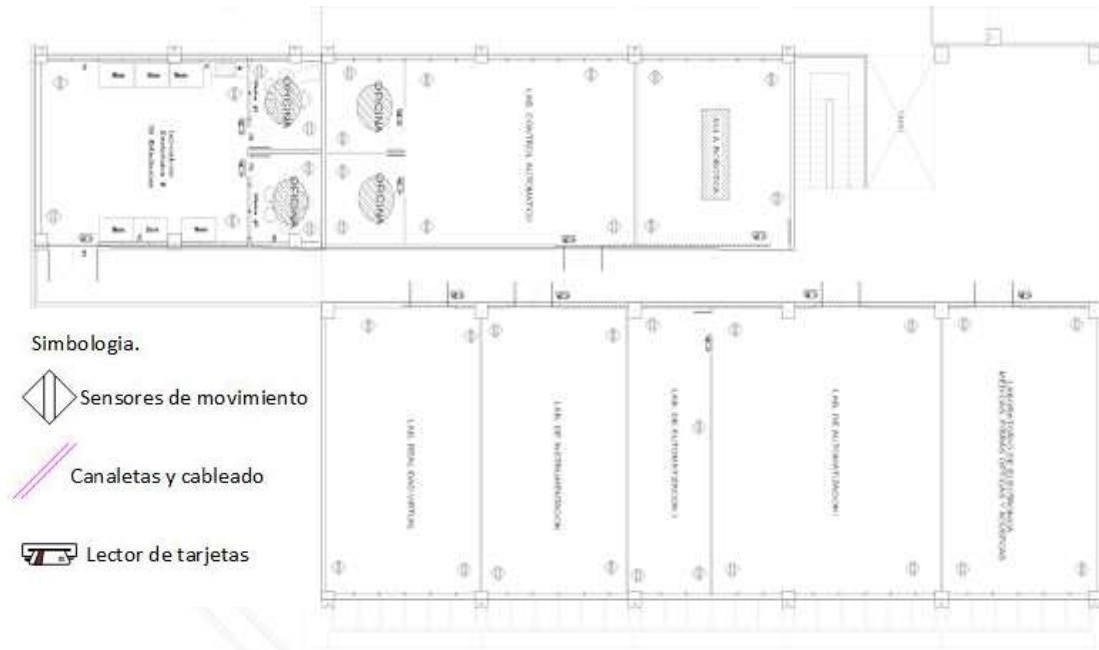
Diseño Estructural del Sistema del bloque 16A planta alta
